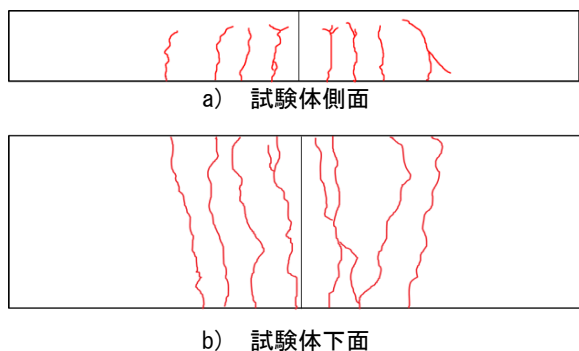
曲げ載荷試験後のひび割れ図 (CASE2)
